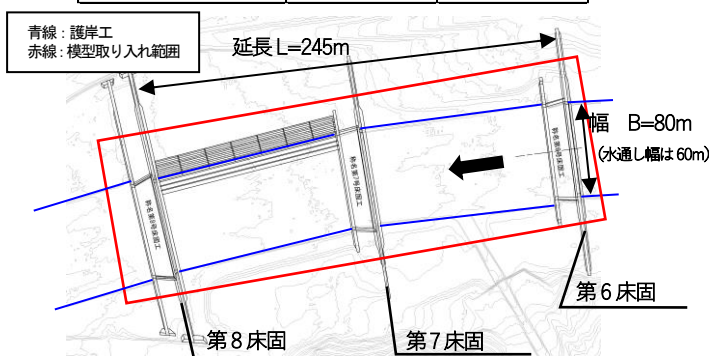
称名川第 8 床固・第 7 床固・第 6 床固 平面図
